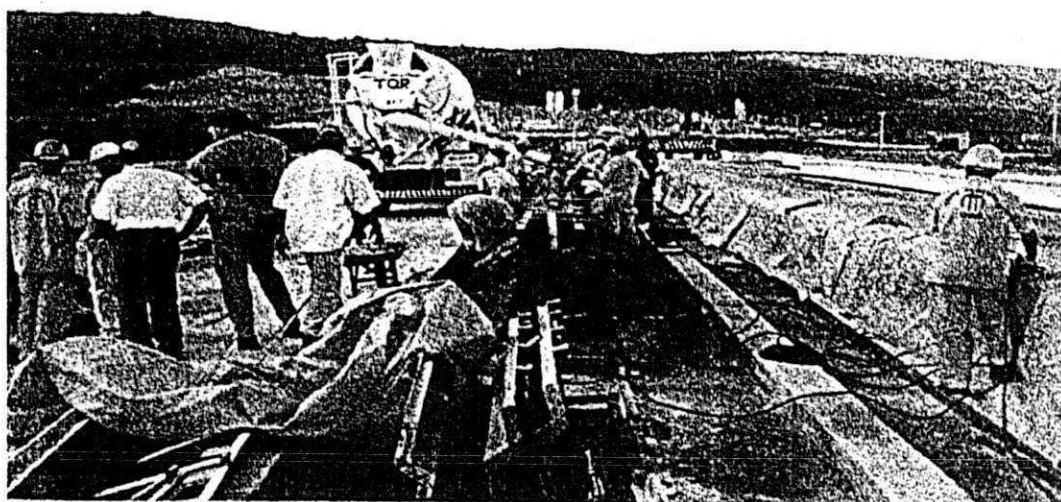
Detalhe da concretagem das vigas no canteiro central.
